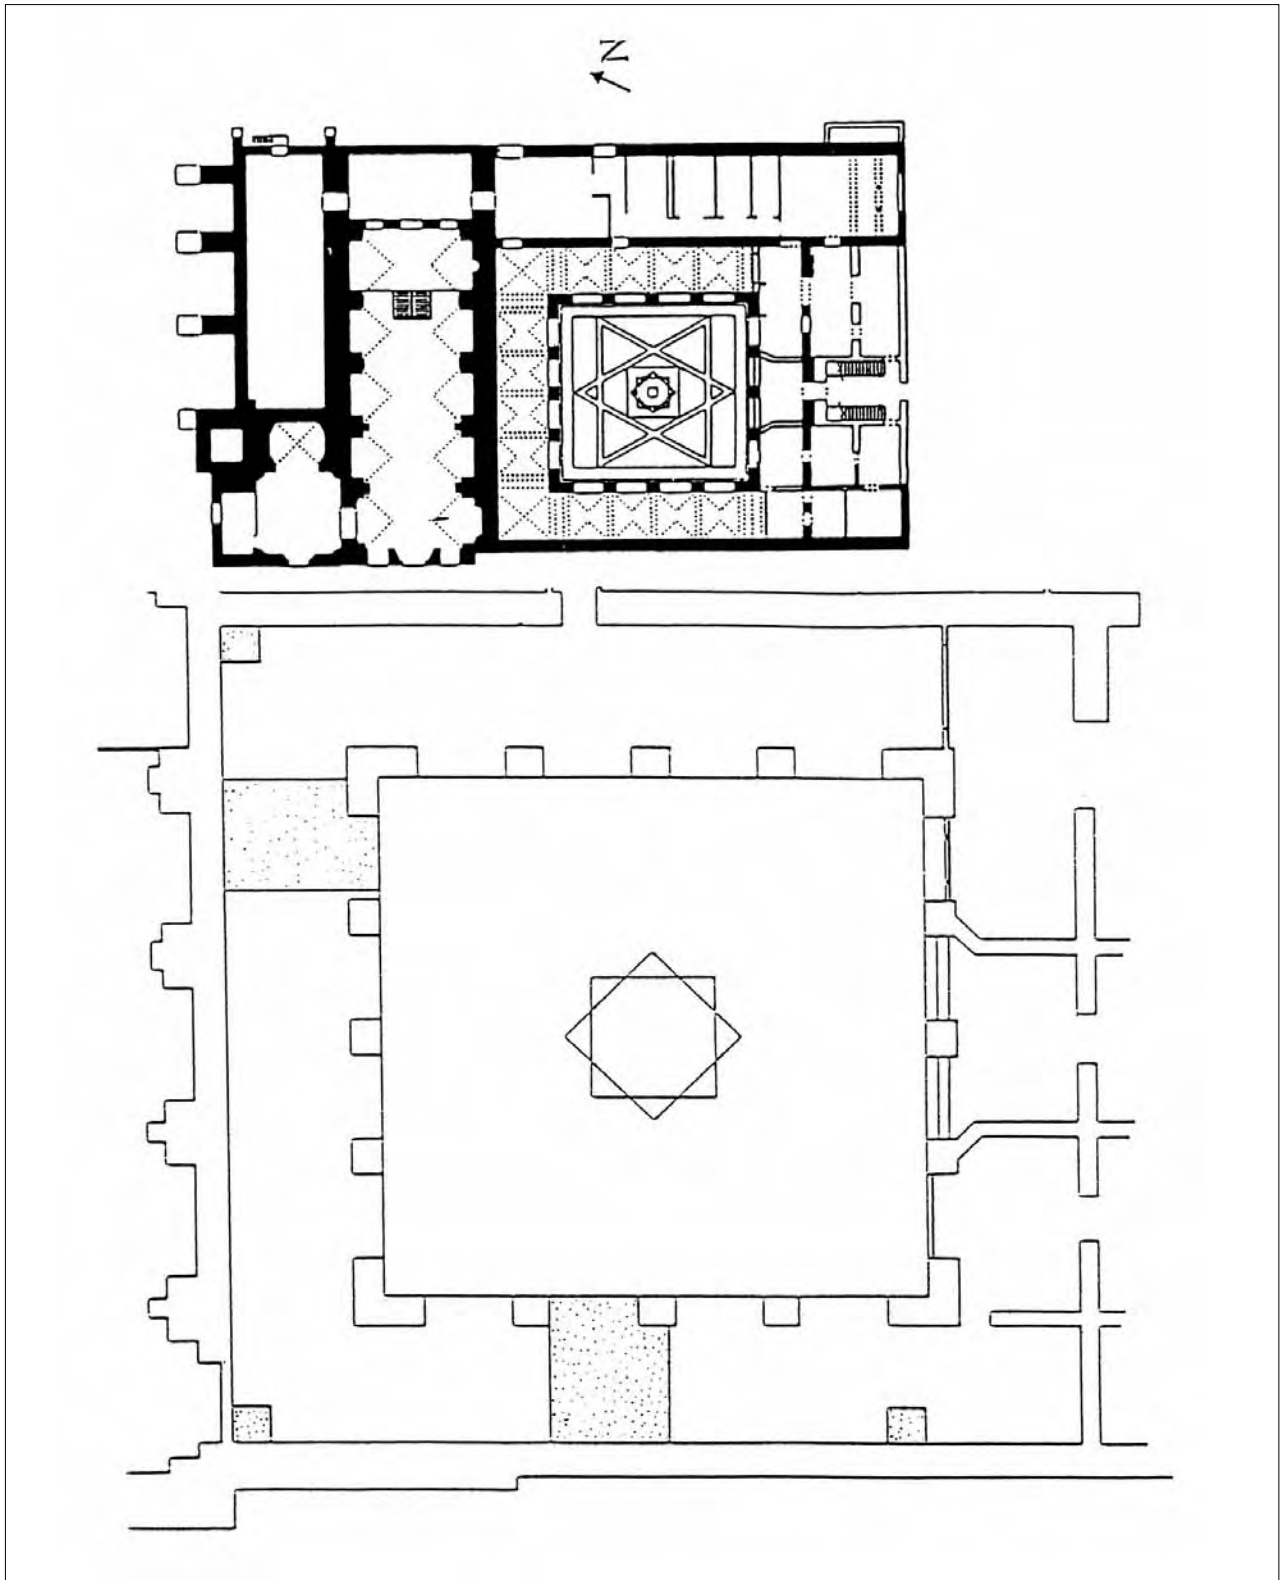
Plano general del claustro con indicación de las áreas excavadas.
